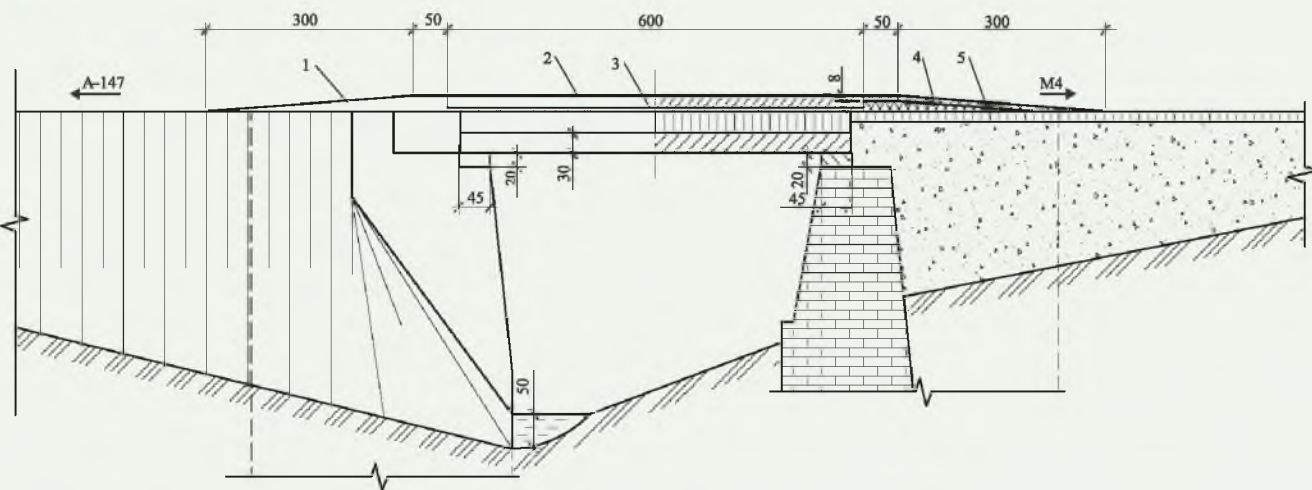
Схема усиления моста № 4 железобетонными плитами:
